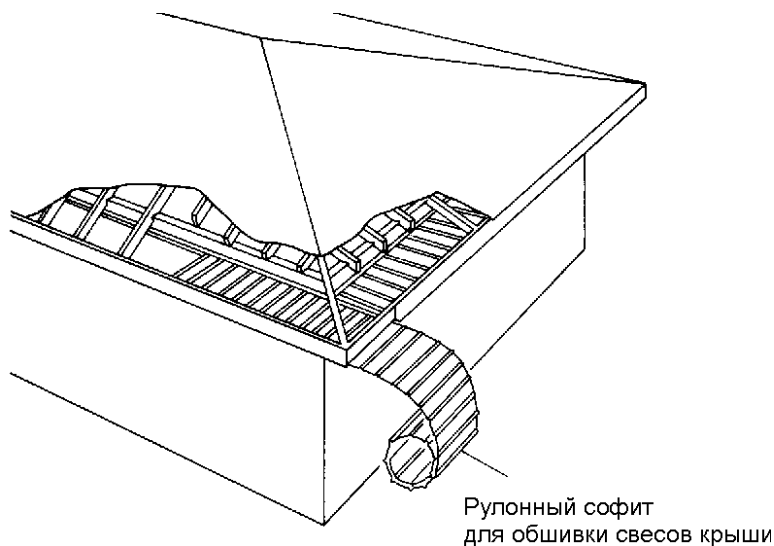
Метод установки алюминиевого материала для обшивки свесов крыши (Reynolds Metals Product)
